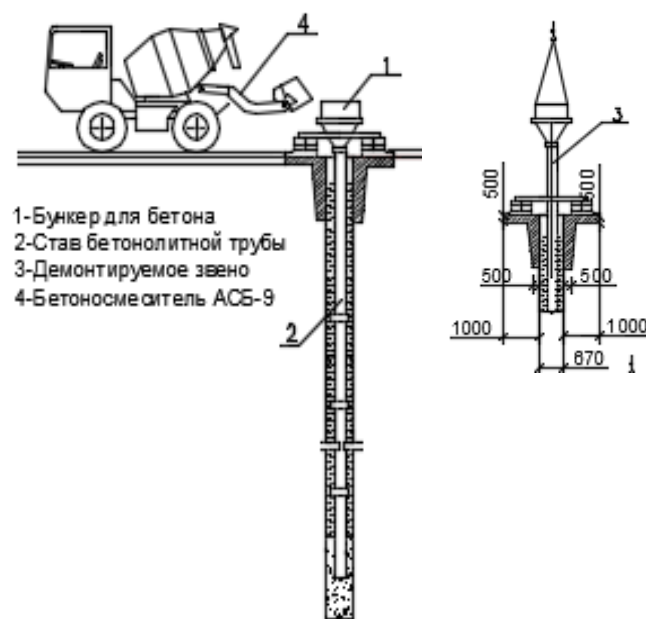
Схема бетонирования: *а* — подача бетонной смеси; *б* — перемонтаж бетонолитной трубы в ходе бетонирования
